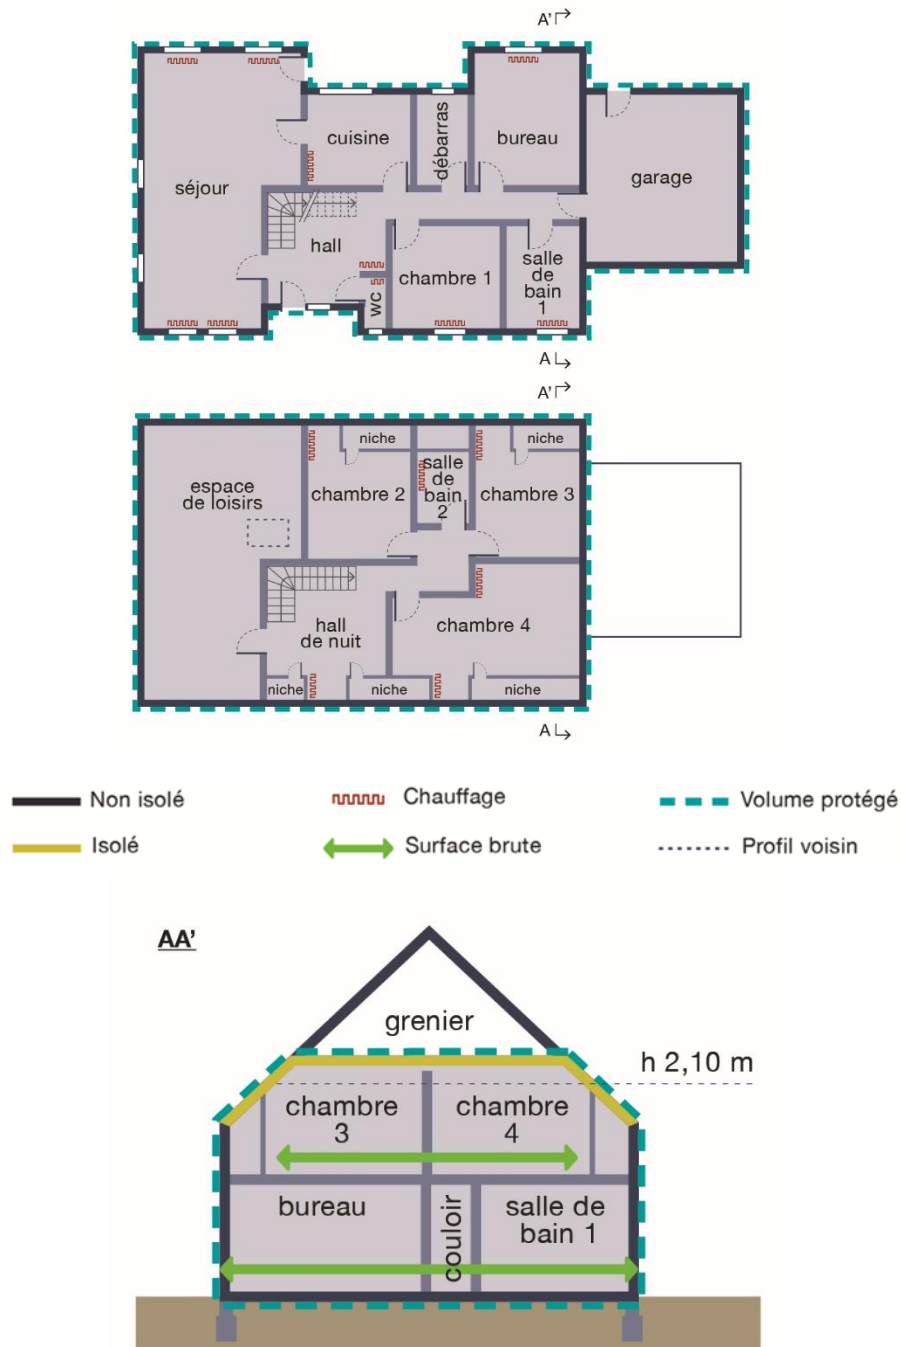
Vue en plan et en coupe d'une villa 4 façades
